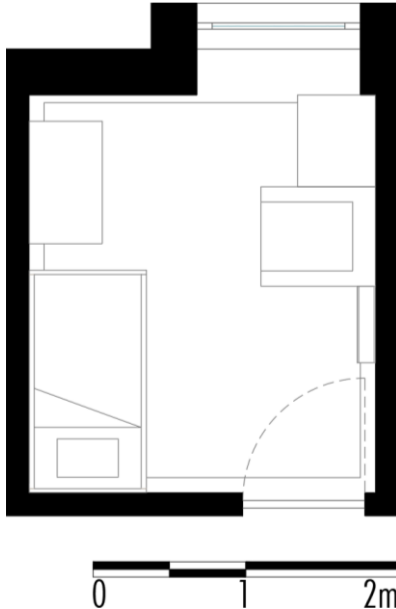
Planta de estudo de *layout* 1 (Fonte: Autora, 2022)
